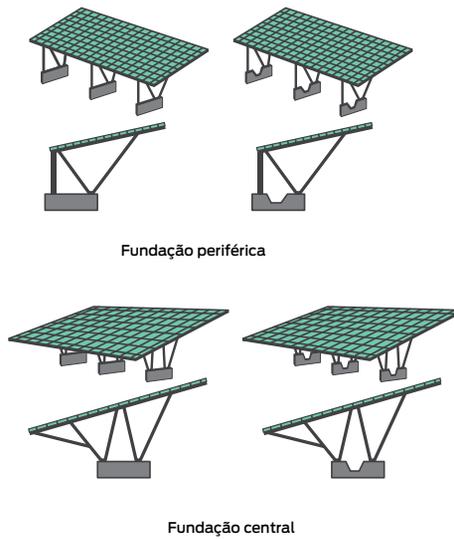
Estrutura tipo CarPort / Fonte: (Donauer Solartechnik Vertriebs GmbH,2009)
